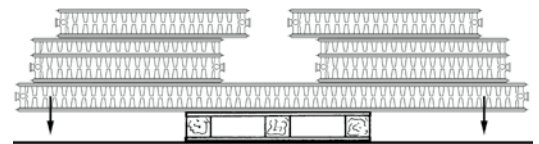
Falsche Lagerung führt zu Beschädigungen
